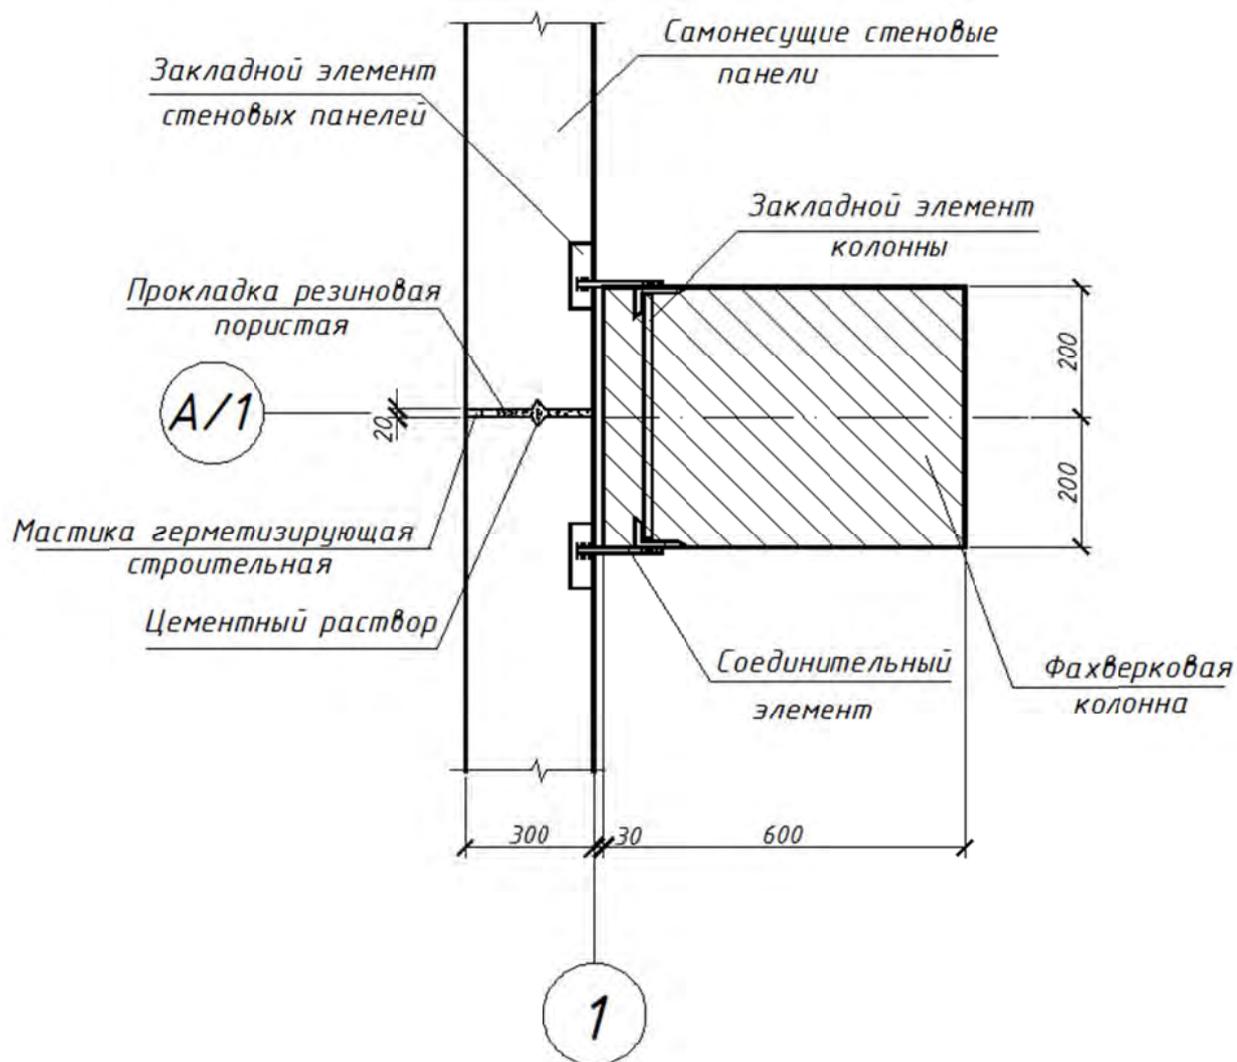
Узел сопряжения фахверковой колонны со стеновыми панелями (план)
